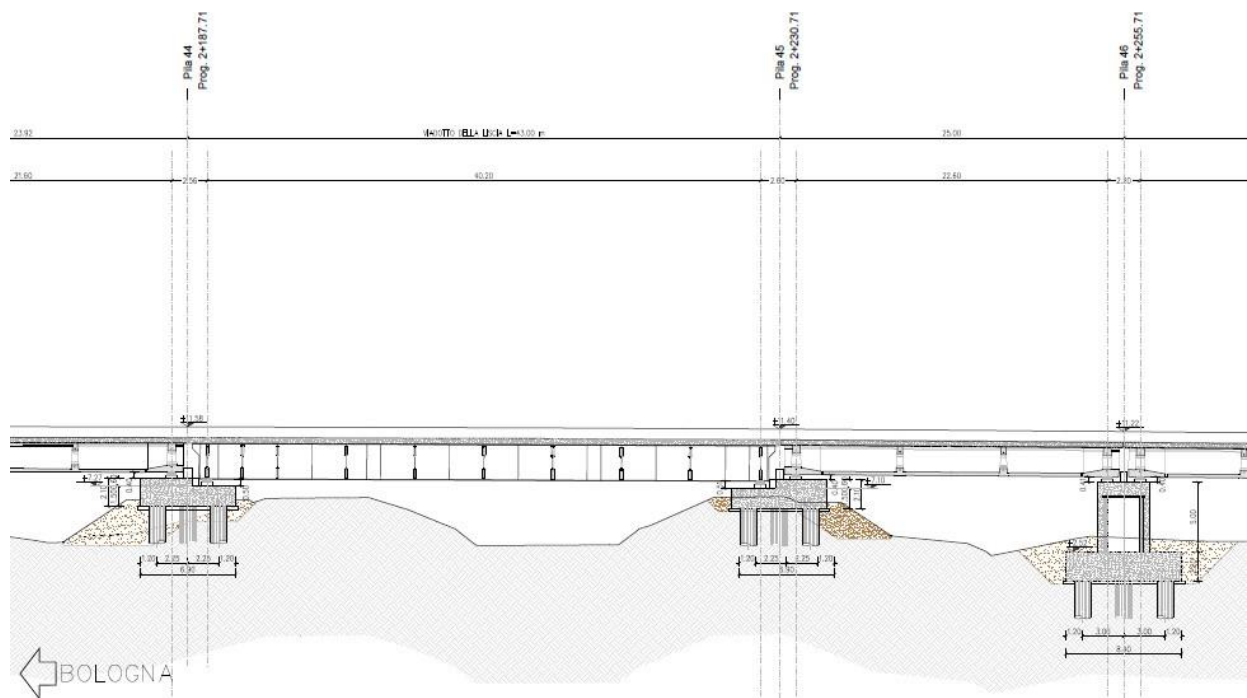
Sezione longitudinale stralcio viadotto Esino pile 44-45-46 in progetto esecutivo 2020
